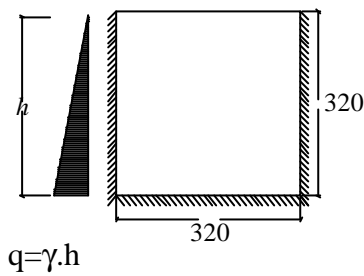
Representação das condições de apoio e carregamento da laje de parede para o reservatório elevado (dimensões em cm).
